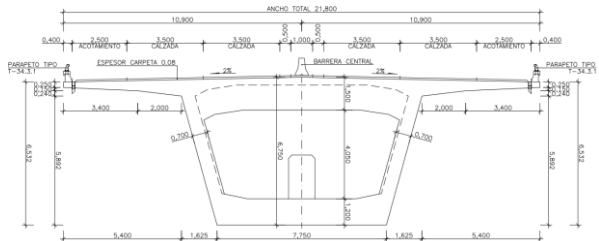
Sección transversal sobre pilas del Puente Las Truchas en el proyecto licitado.
